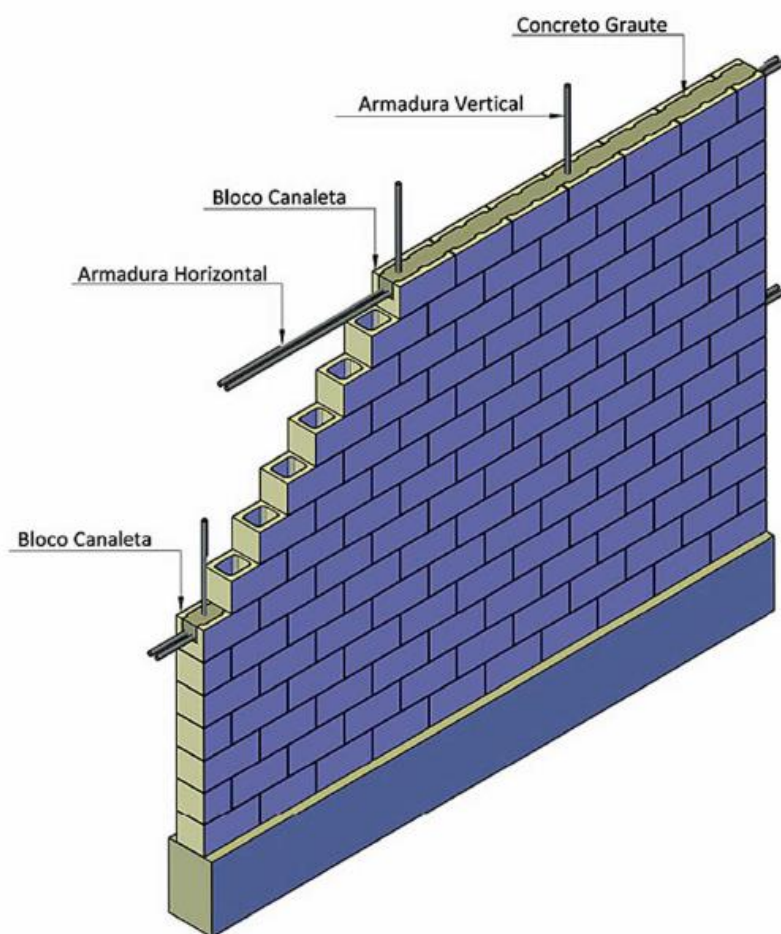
Rescaldo intermediário e rescaldo do primeiro pavimento. Fonte: Tauil; Nese (2010)
